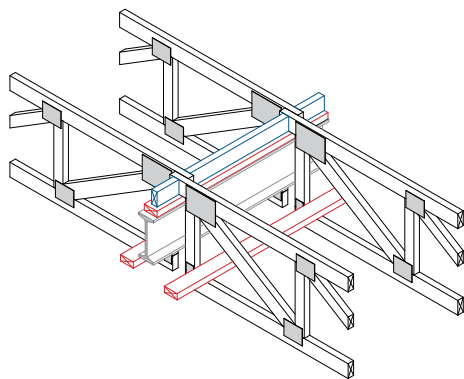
• Fermes appuyées sur le dessus de la poutre d'acier
